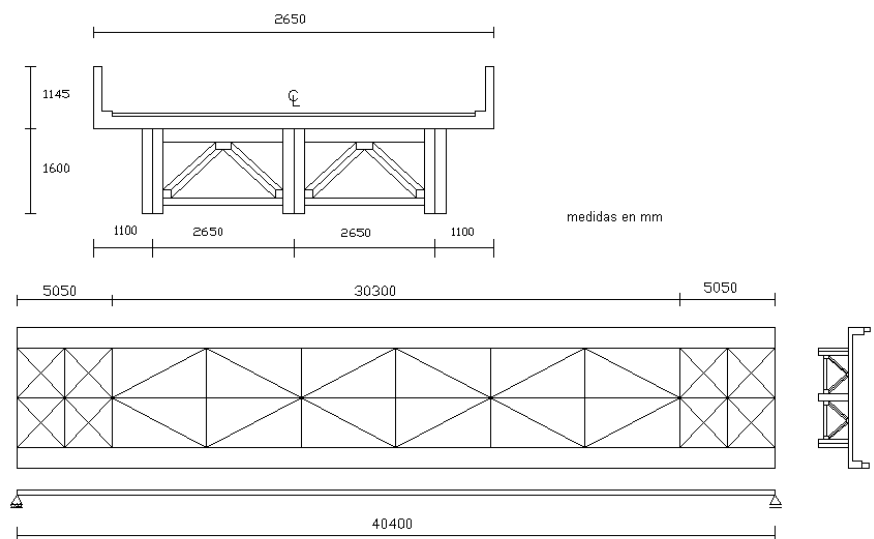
Secciones del puente de concreto reforzado. Disposición general
